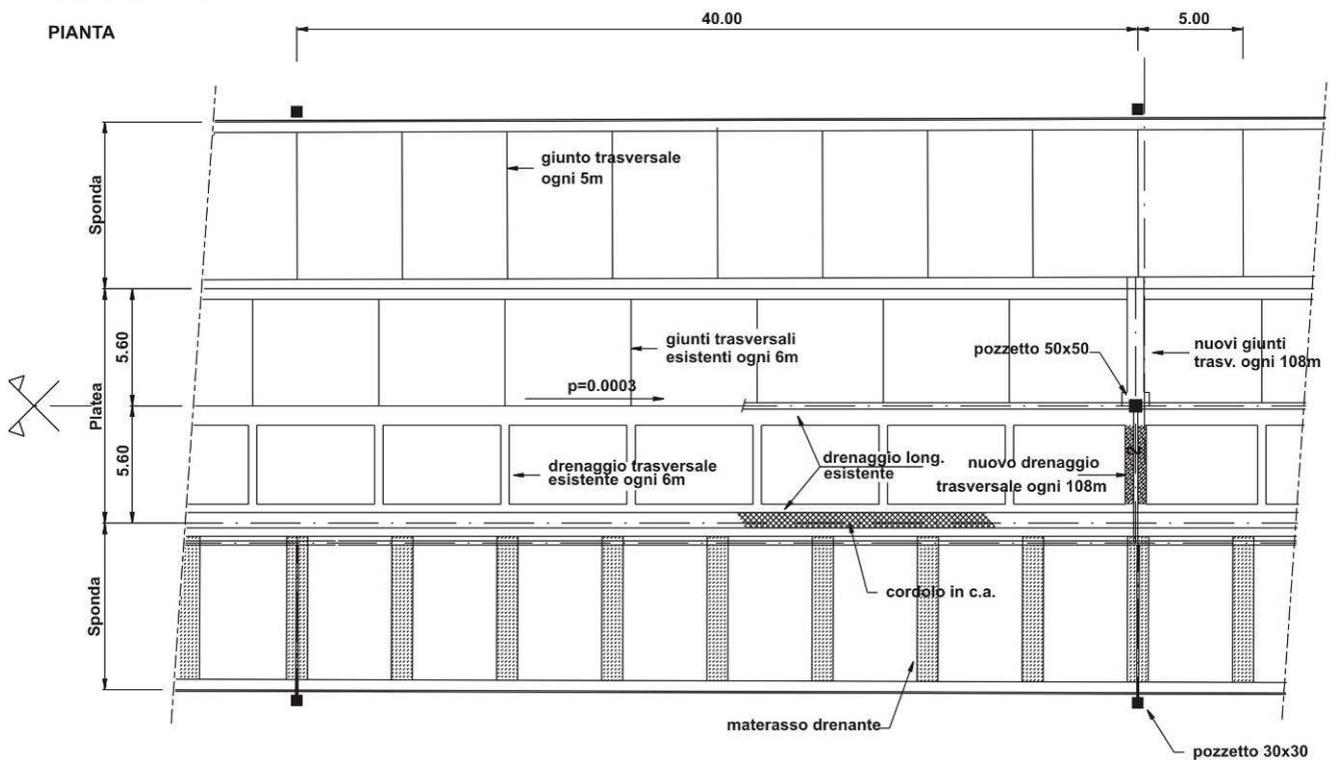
pianta di un tratto dil canale prima e dopo l'intervento
